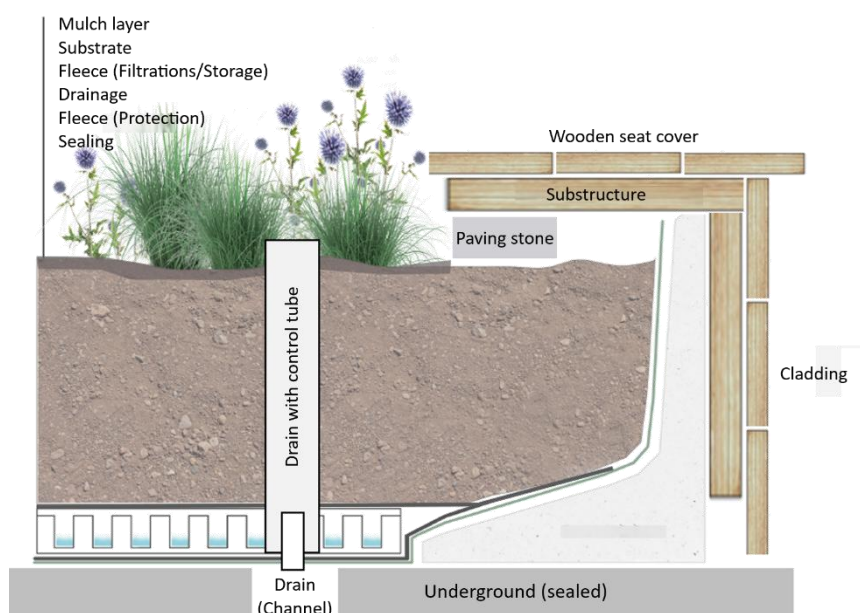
Construcción de una zona de plantación densa a modo de pop-up con piedras de esquina de hormigón y soporte de asiento de madera
